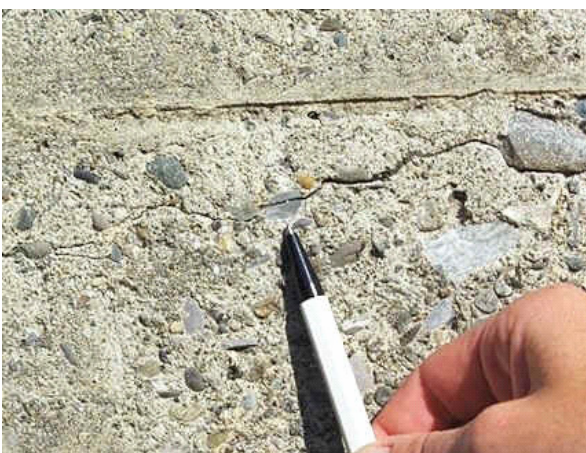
Betonoberfläche mit typischem Rissverlauf quer durch Gesteinskörner
